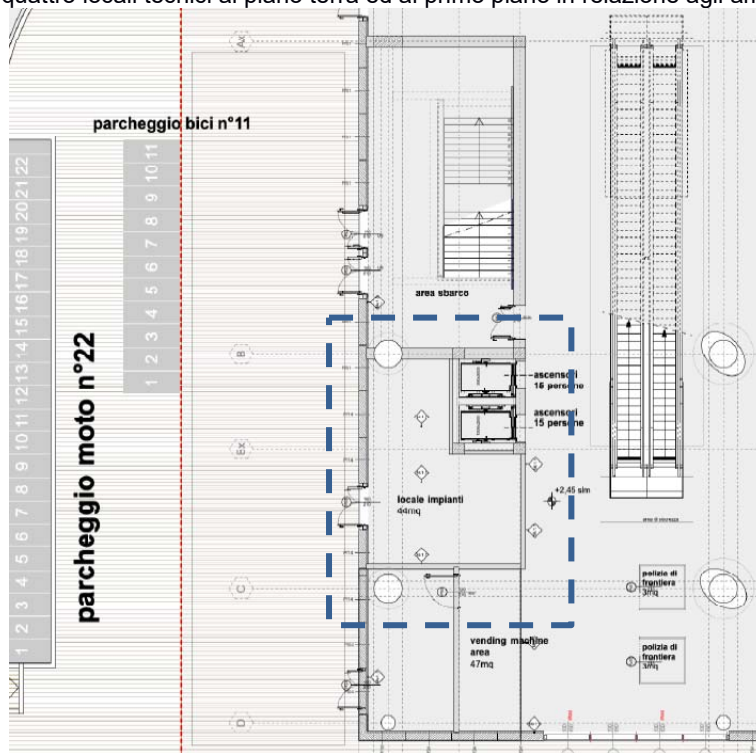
Piano terra, lato nord: locale impianti (dettaglio)
